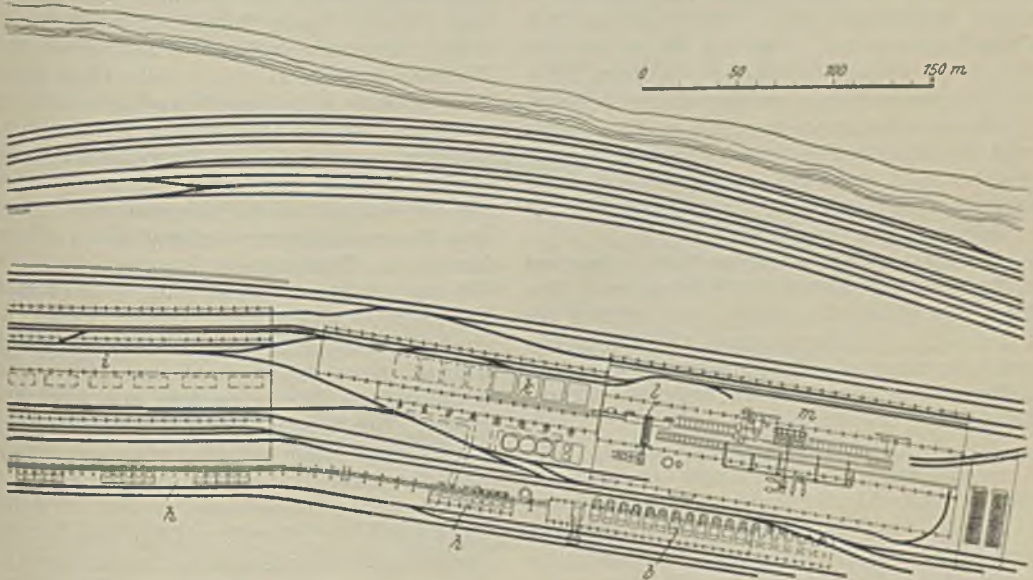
Lageplan der Brier Hill Steel Co. in Youngstown.
